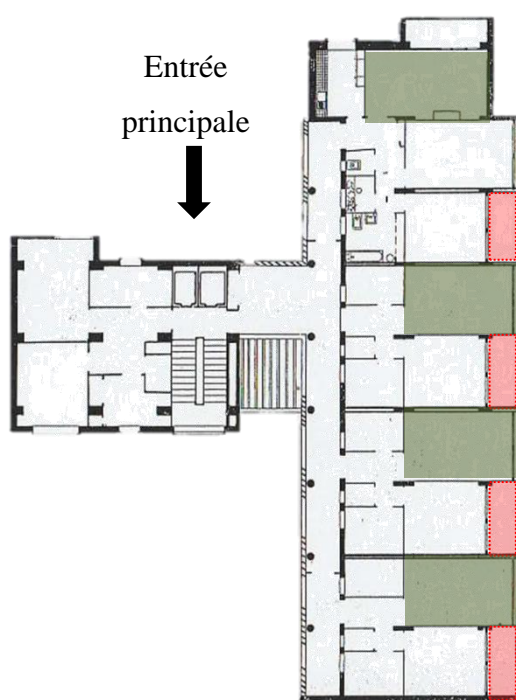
Extraie du plan d'étage courant (Revu Chantier N°23- 1954 p 21)
